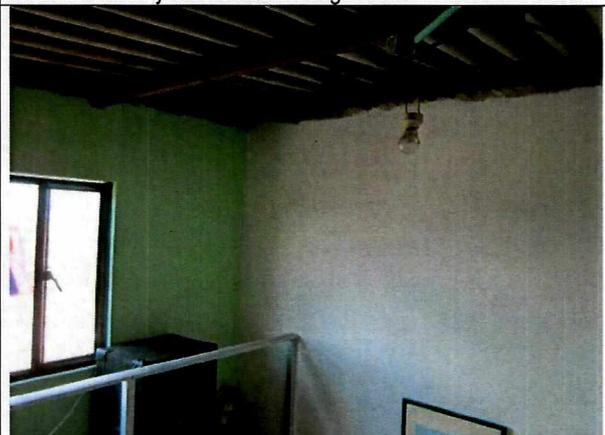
Muros internos del tercer piso o attillo, sin daño.
